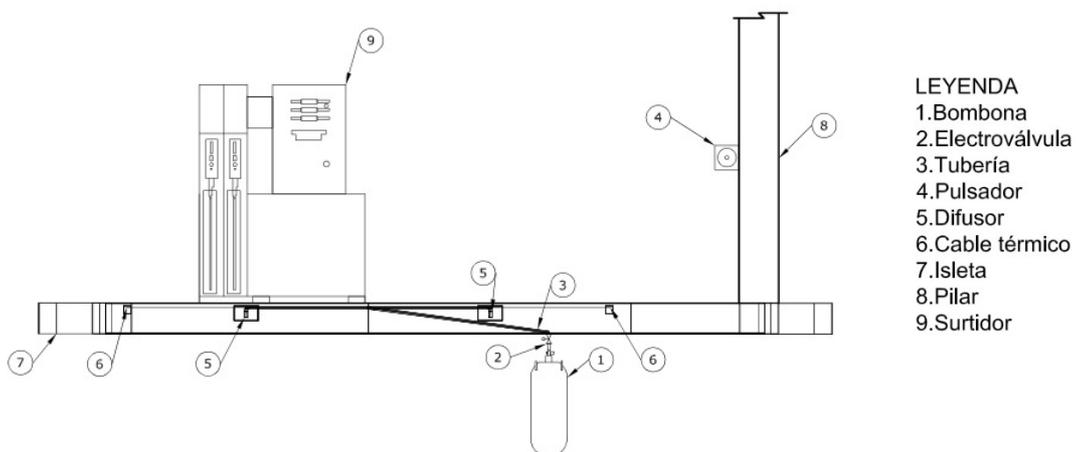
Disposición de los elementos del sistema KIT PETCI, en alzado
